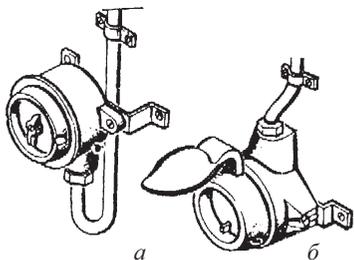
Установка выключателя и штепсельной розетки с кабельной проводкой:
